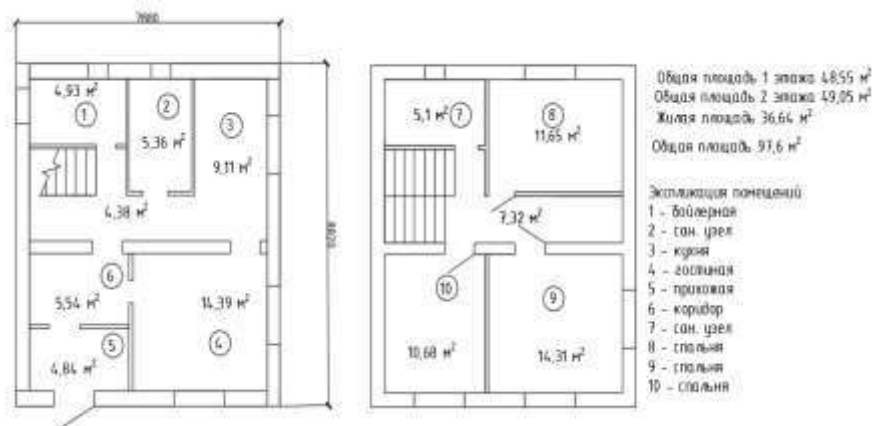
План двухэтажного дома со стенами из силикатного кирпича
